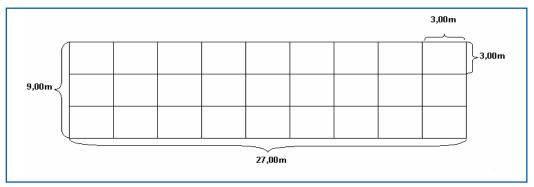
Planta baixa da estufa modelo 'lean-to'.
